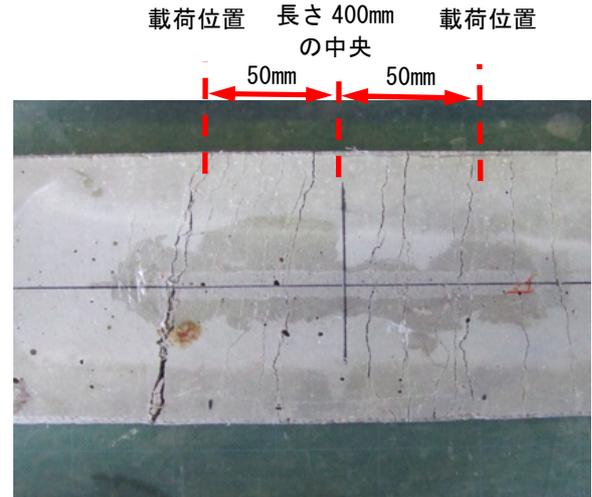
軽量細骨材を使用した低弾性高じん性モルタルの曲げ強度試験後の供試体下面に発生するひび割れの違い
